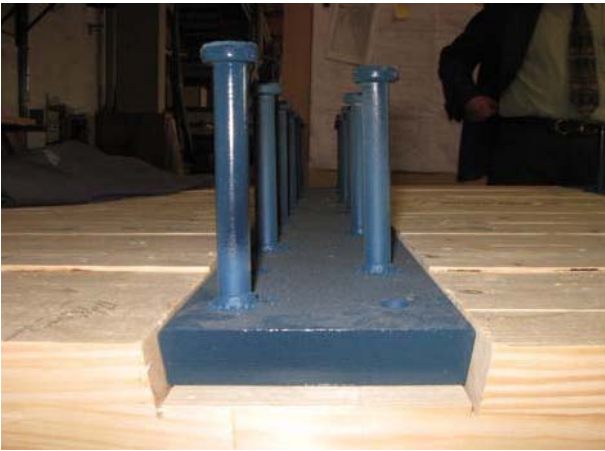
Blockverleimter Holzträger mit Dübelleiste
